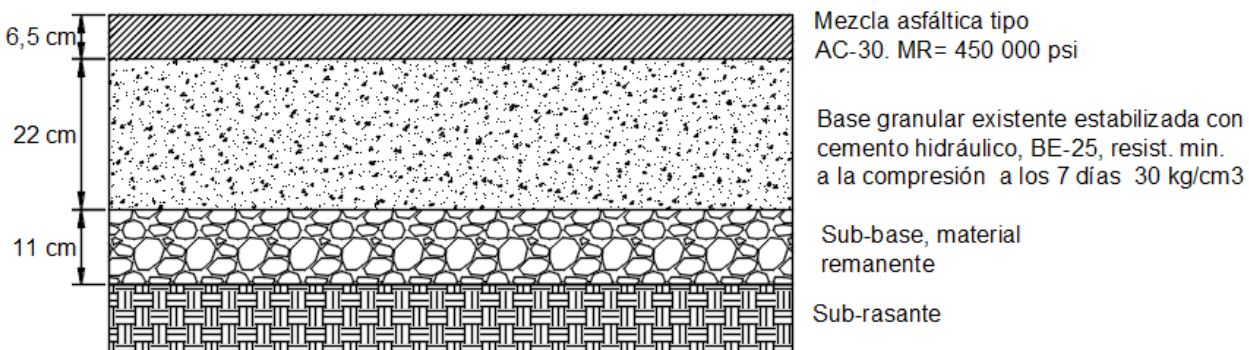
Perfil de la estructura de pavimento propuesta para el TH=16.
